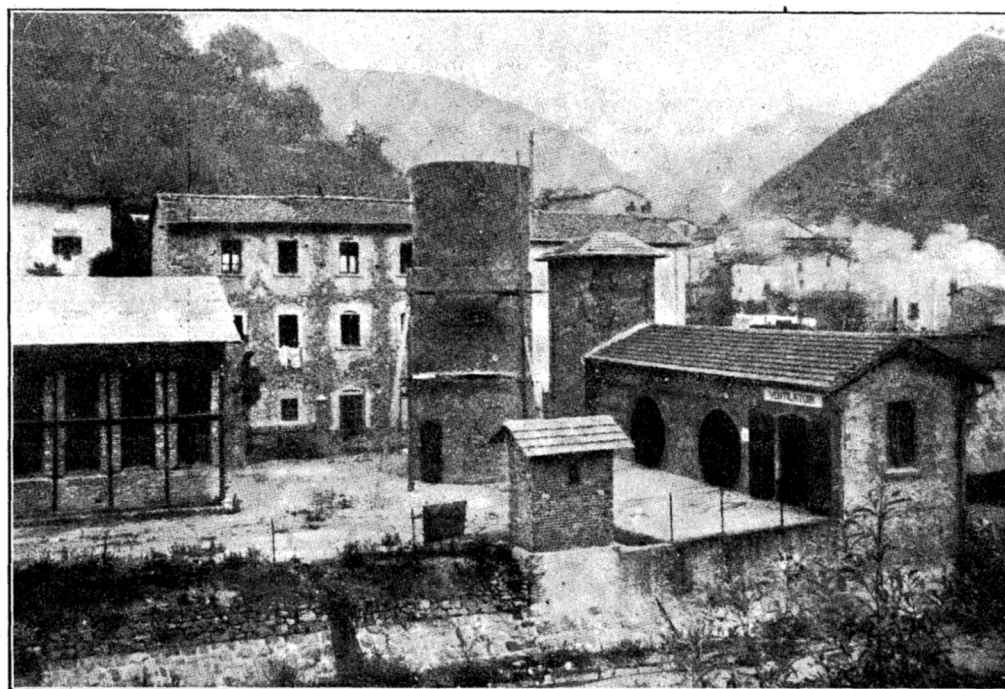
Impianto di ventilazione per l'imbocco Sud al pozzo di Vernio.
